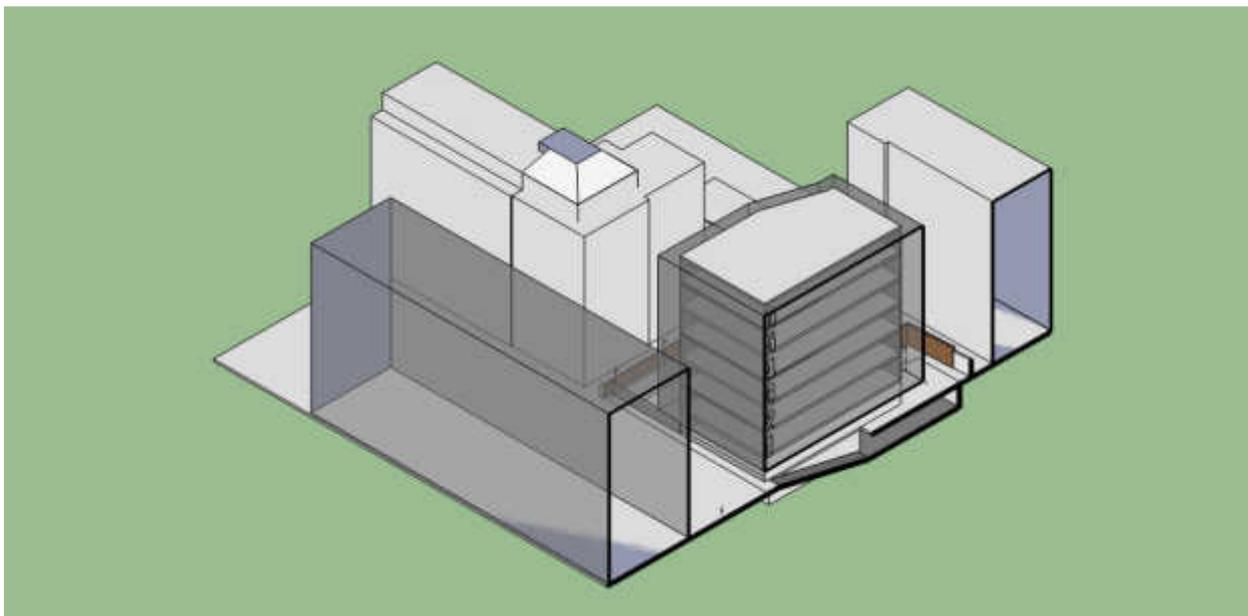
sezione assonometrica trasversale su via Piave – schema di progetto
